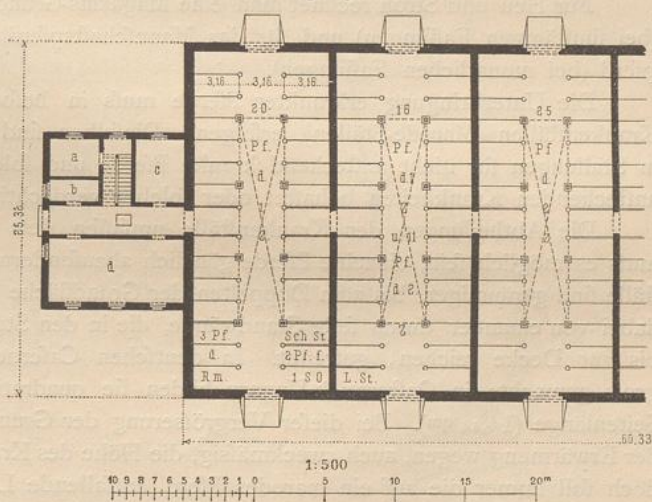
stellt den halben Grundriß eines österreichischen Escadron-Stallgebäudes mit Querreihenstellung<sup>496)</sup> dar. Die Erleuchtung wird hauptsächlich durch große Deckenlichter in den Dachflächen bewirkt.
